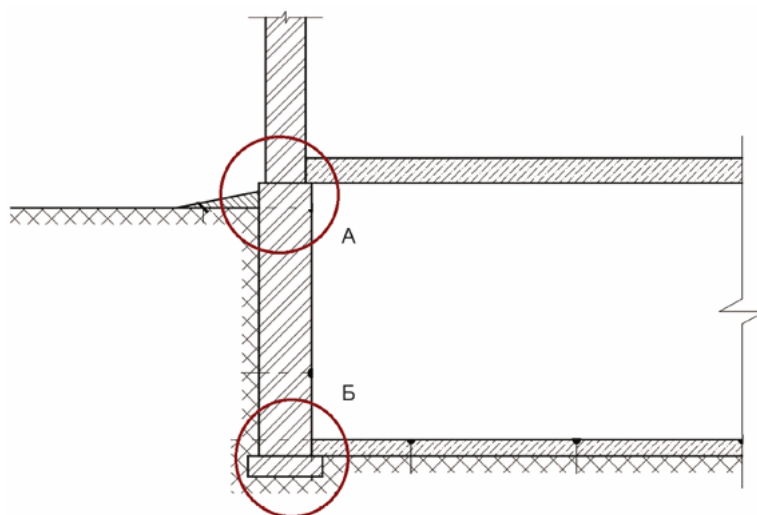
Стык стены вне грунта со стеной в грунте (А) и стык стены в грунте с полом в грунте (Б)
